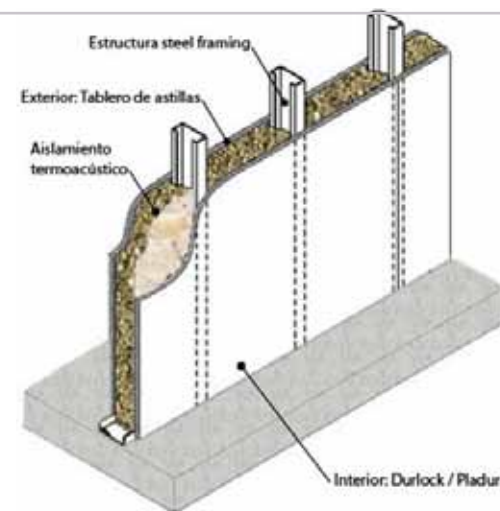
Aislamiento acústico para paredes livianas con aislante interno. Laminas de Gypsum de 5/8 de pulgada. STC=48
